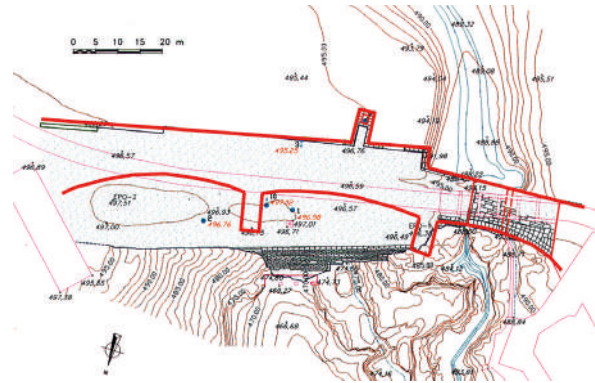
Planta general de la presa (dibujo de Arenillas *et al.* 1996). En rojo, la planta de la presa romana con detalle del aliviadero, a la derecha.
